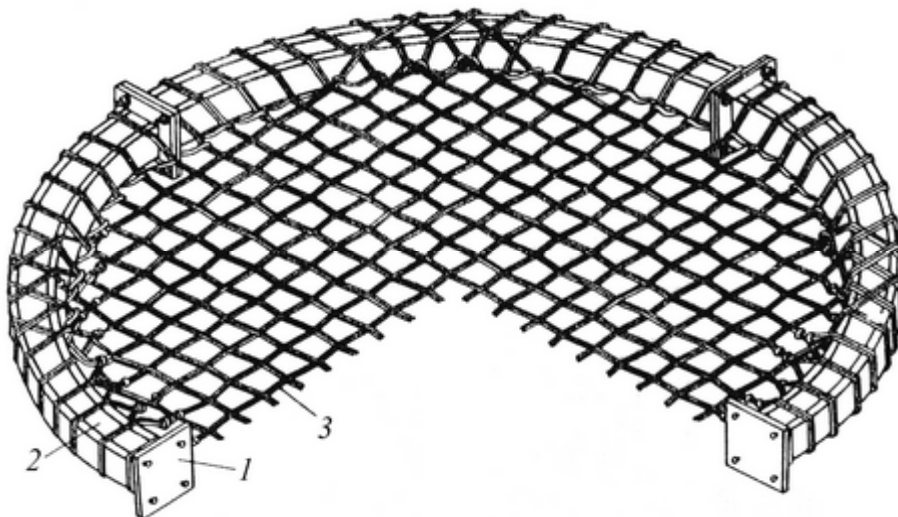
Конструкция опорного кольца для крепления одноярусной канатной сети:
